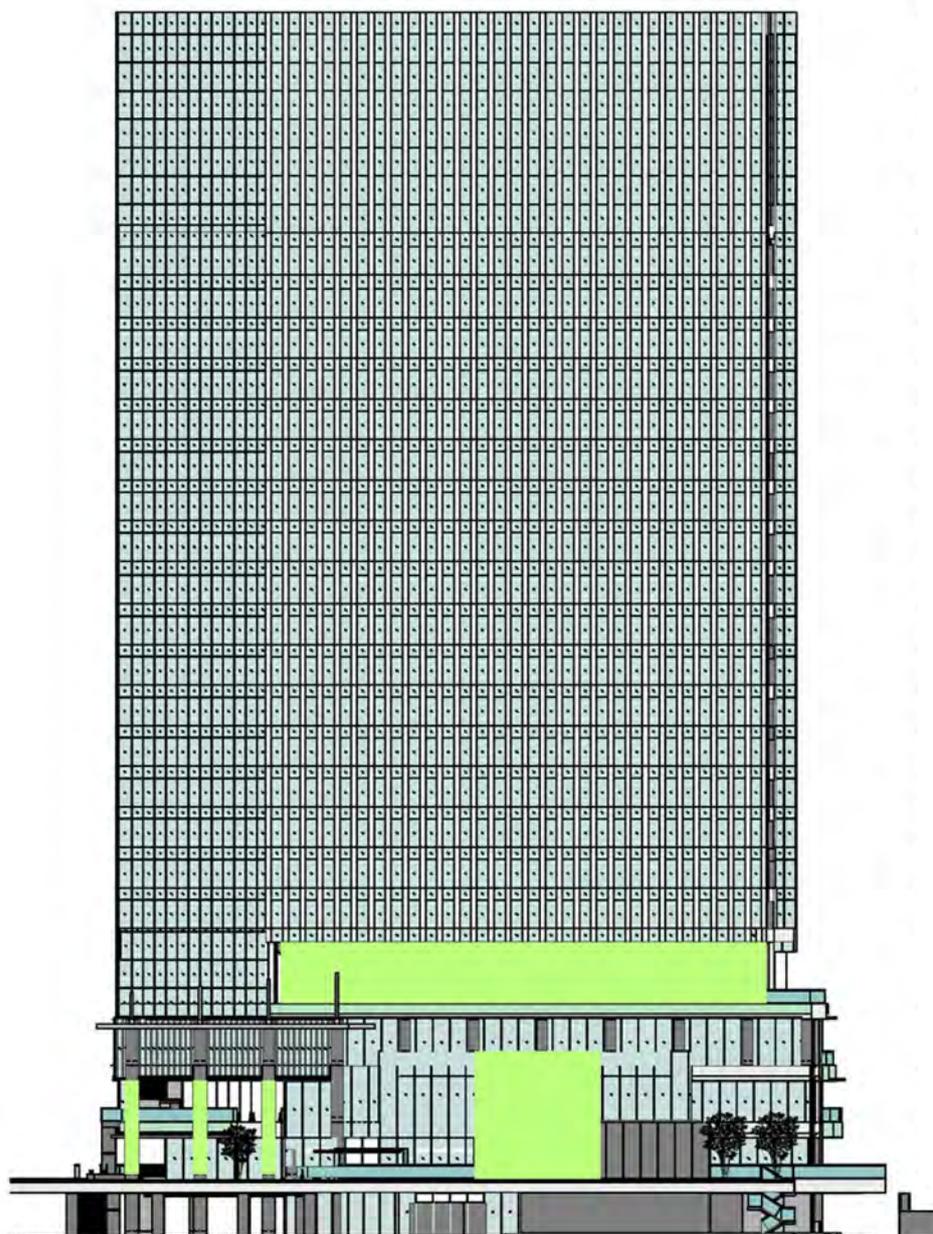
(2) 立面图 (南立面图 S=1:800) 【变更前】
